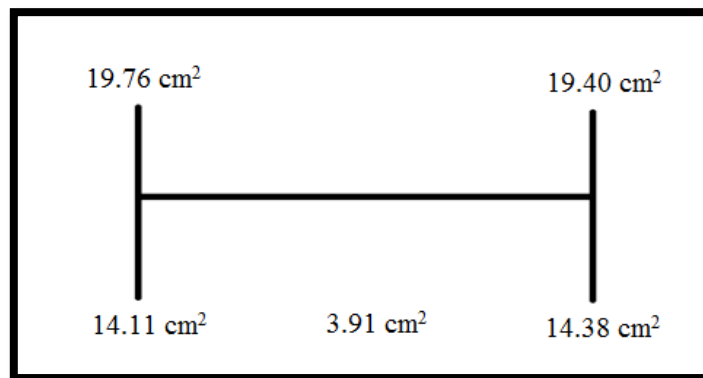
Área de refuerzo requerido en la viga de diseño.
